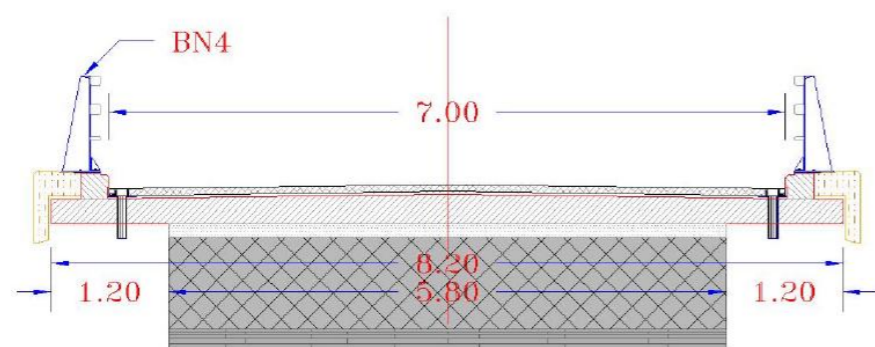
Coupe type de renforcement de l'ouvrage extérieur ou intérieur
